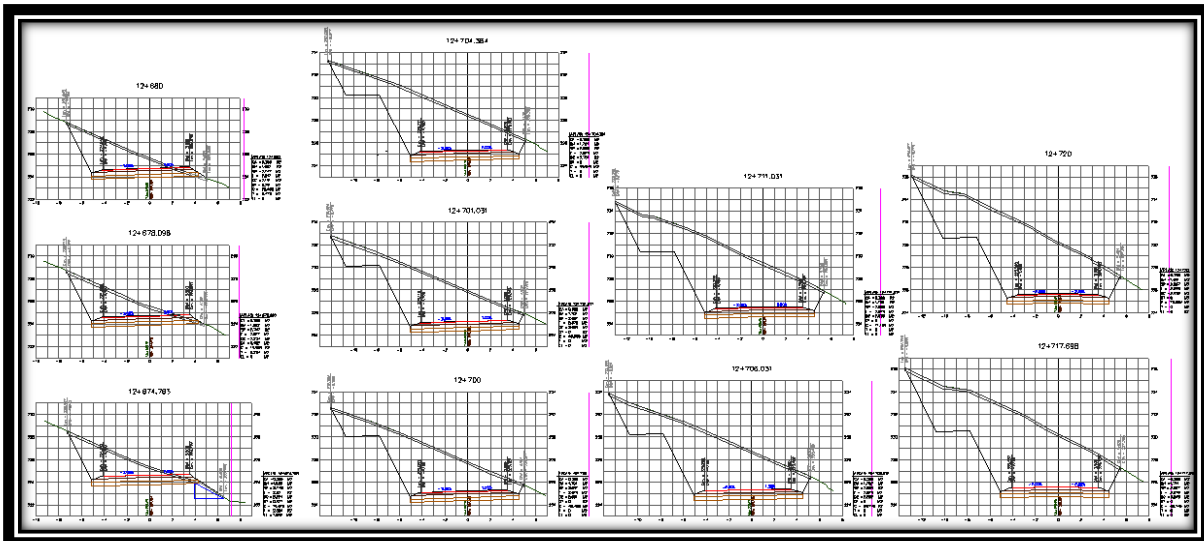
Secciones de construcción del km 12+674.763 al km 12+720.000.
